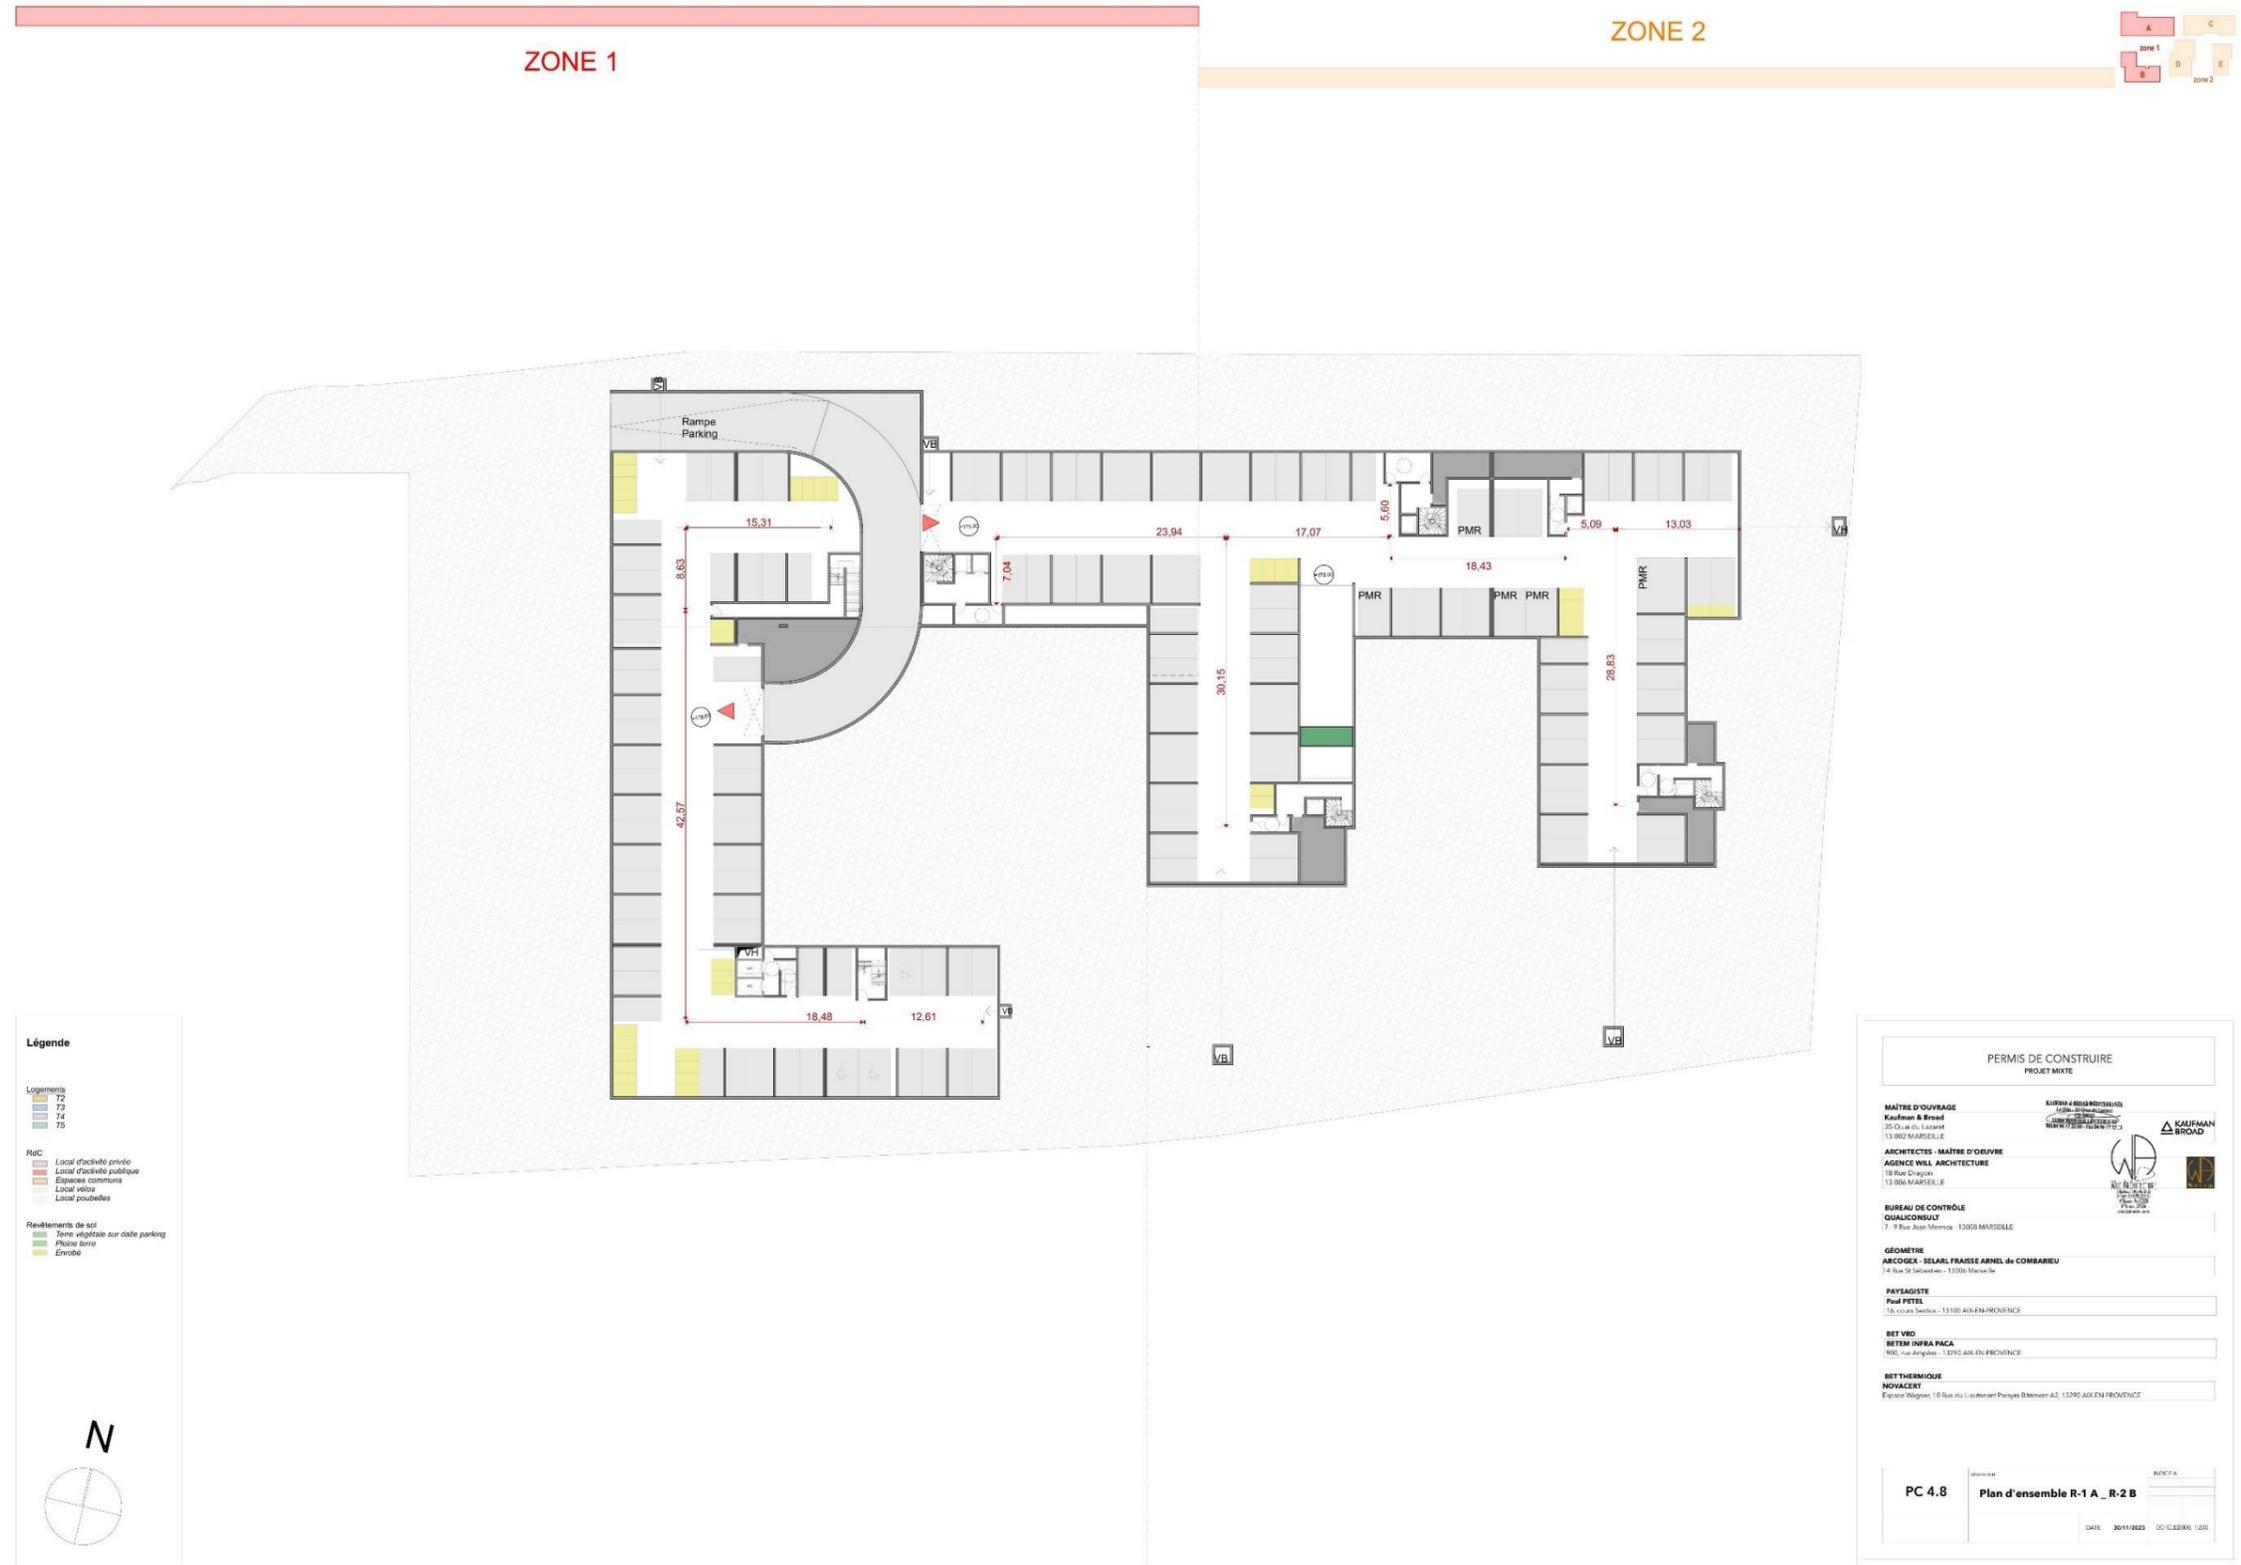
Plan d'ensemble R-1 A et R-2 B (Source : Kaufman&Broad)
